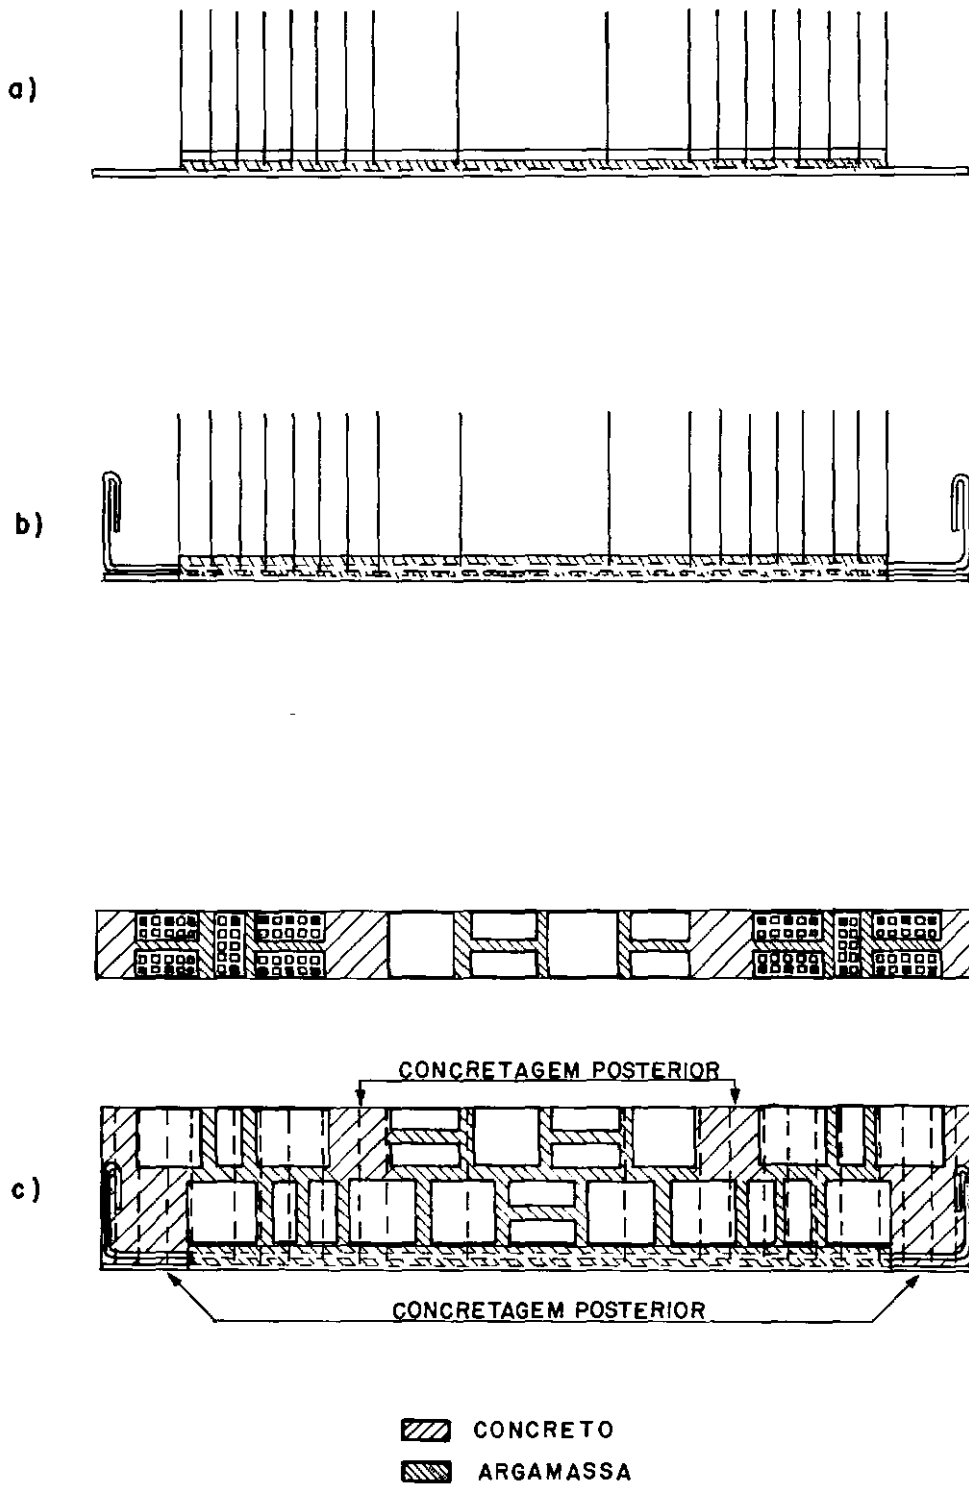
EXECUÇÃO DAS VIGAS " SEM BLOCO "
